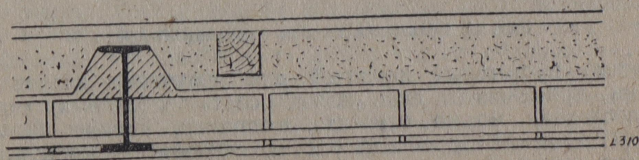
Перекрытие из потолочного кирпича Клейне. Продольный разрез
